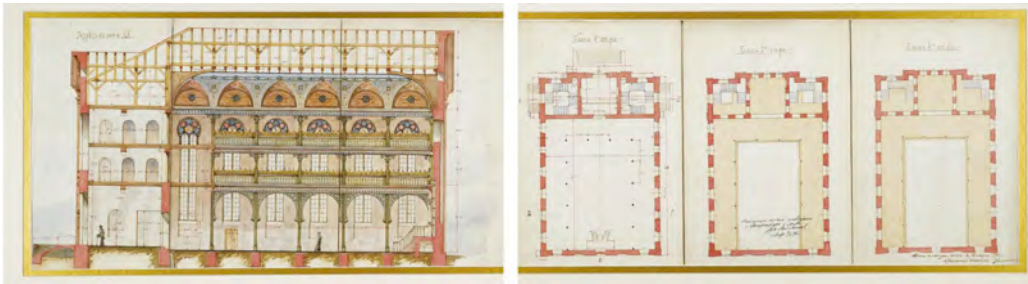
Längsschnitt und Grundriss; Pläne von Adolf Zeligson
